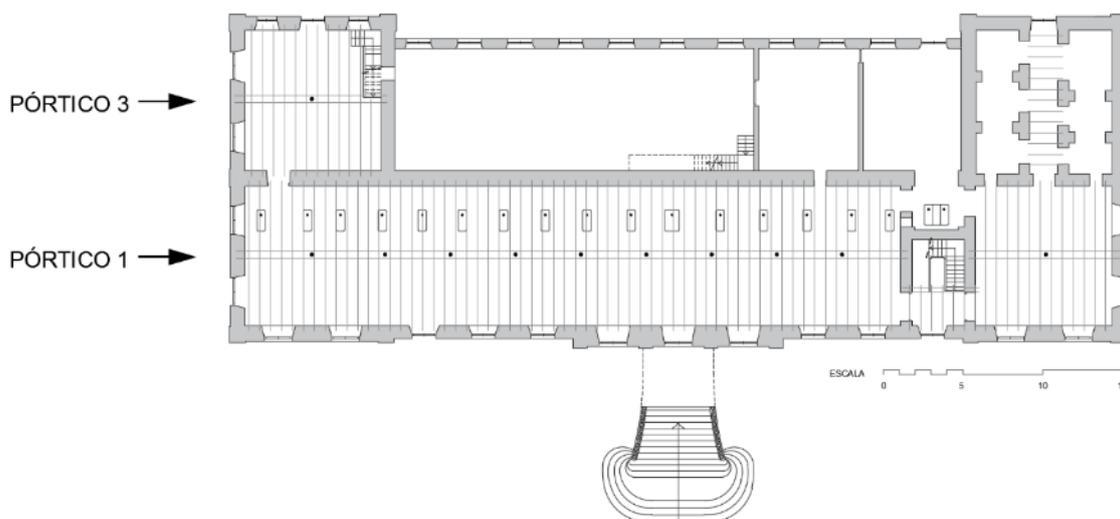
Esquema estructural. Pilares de planta baja y forjado de planta primera.
